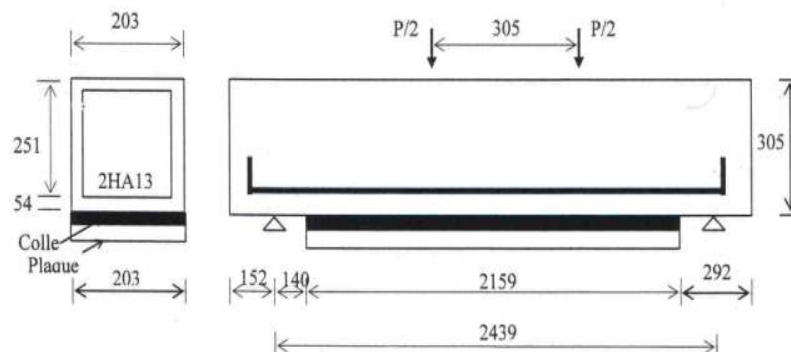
Montage de la poutre renforcée par une plaque de CFRP (S6-PRE3) [38]
